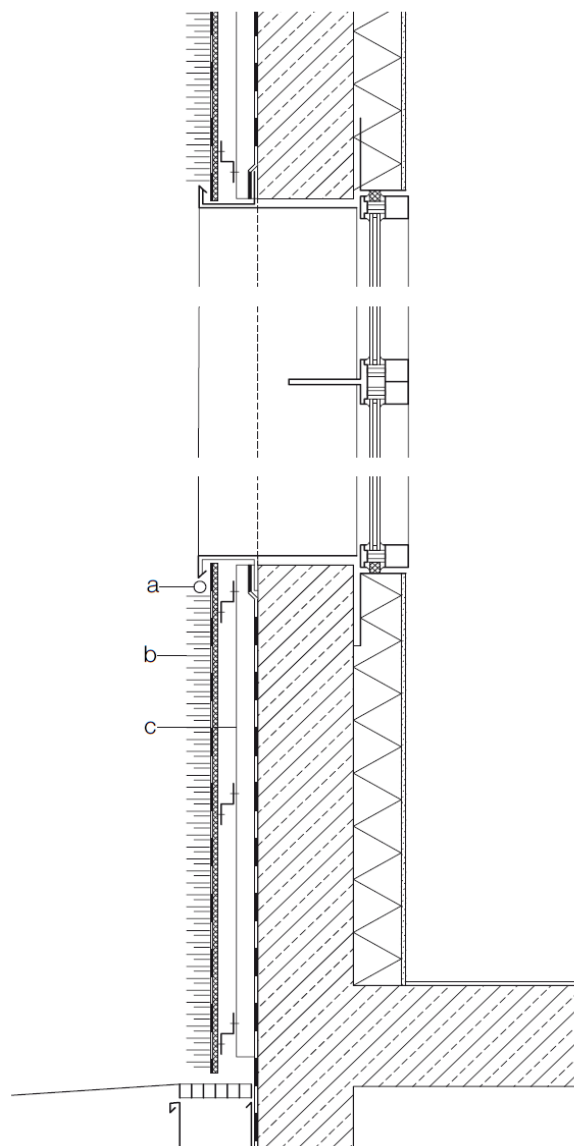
Pormenor construtivo da parede viva hidrópica do museu Quai Branly, com destaque para a existência de uma caixa-de-ar isolada entre a parede estrutural e a estrutura verde. a) Tubo de rega perfurado em poliuretano; b) plantas suportadas pela dupla camada de feltro; c) estrutura de aço inoxidável e conseqüente caixa-de-ar (Retirado de: Kaltenbach, 2008)
